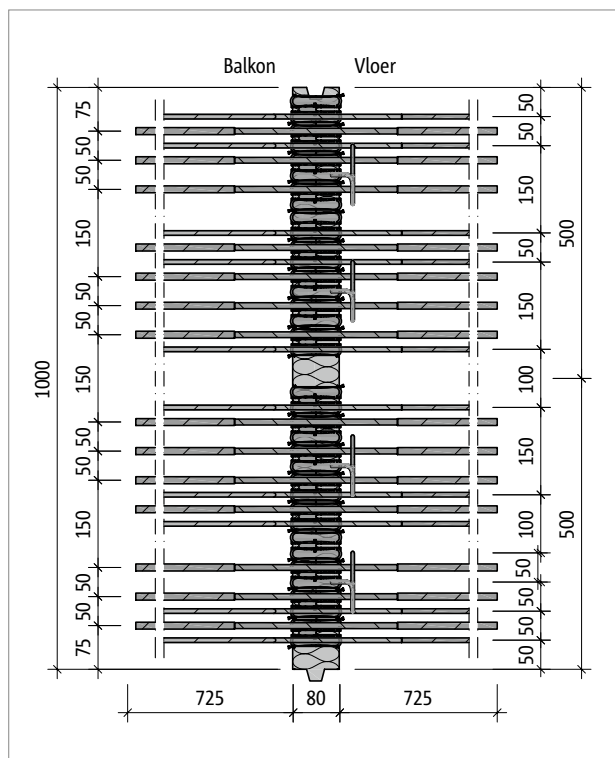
Schöck Isokorf® T type K-E-M6, K-T-M7, -M9, -M10: Zijaanzicht
